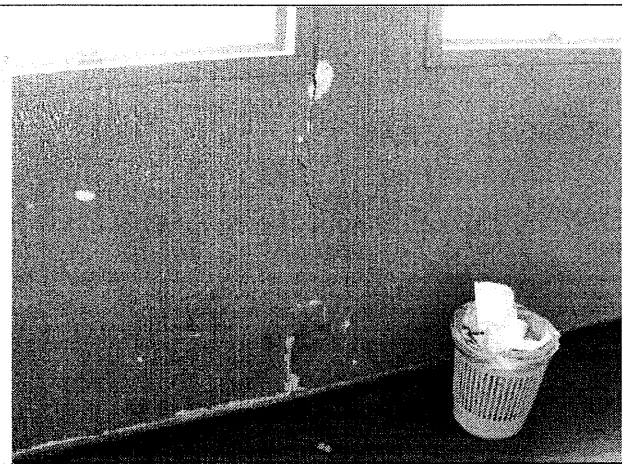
Agrietamiento en muro del costado oriental de la biblioteca del colegio Simón Bolívar sede A.
